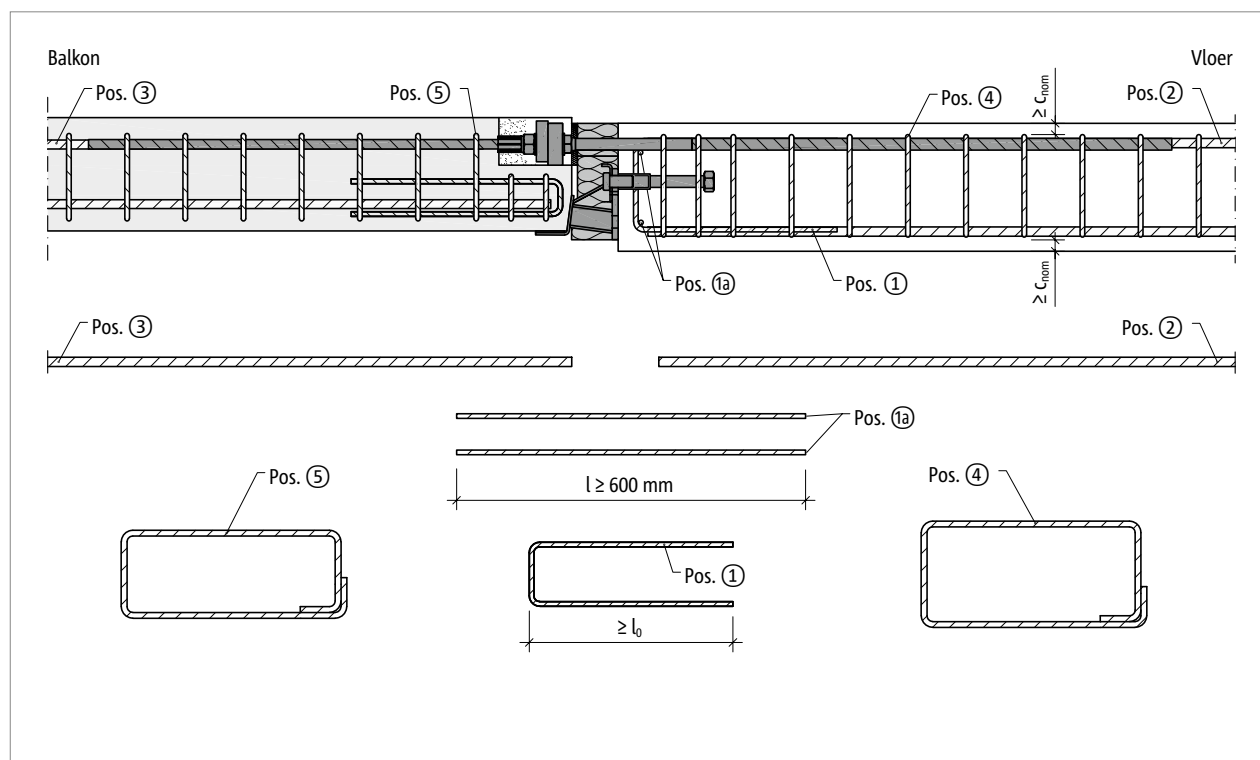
Schöck Isokorf® IQ type K-A: Bijlegwapening
